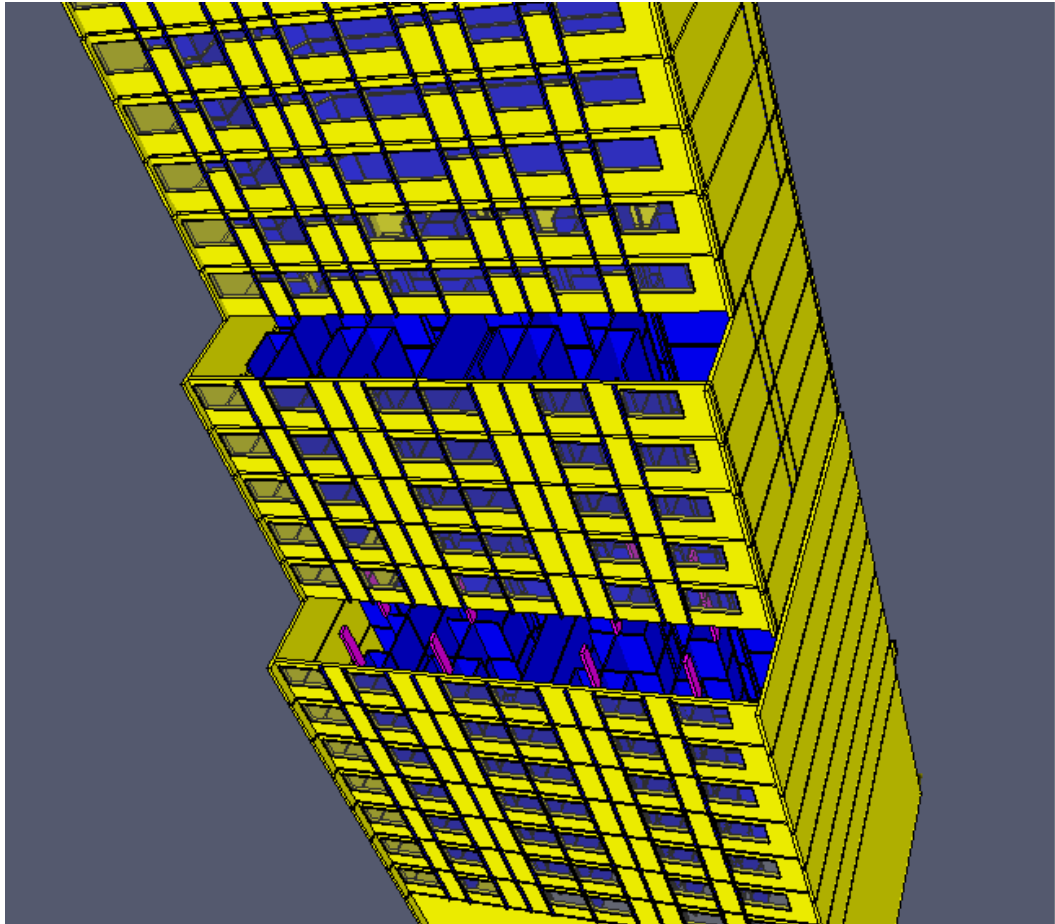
Detalhe da fachada com janelas e sem laje (PYROSIM, 2010)
